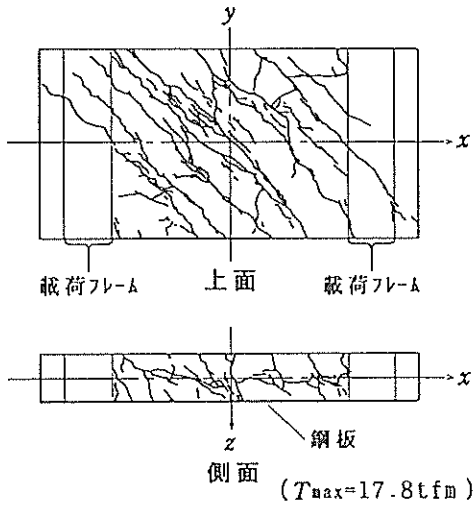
供試体 OS-22-150のひび割れ発生位置
